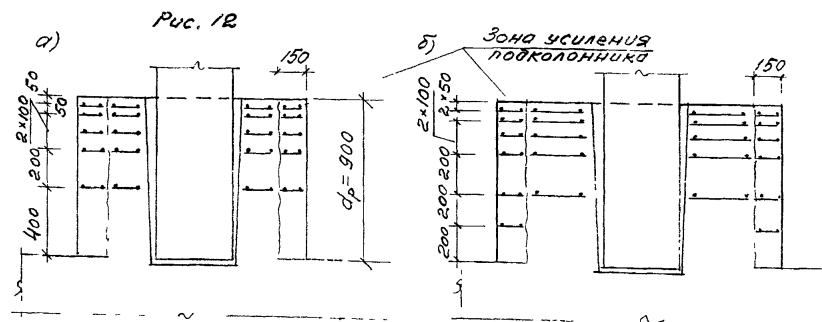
а) поперечное армирование стенок стакана усиленного подколонника фундамента под усиленную рядовую колонну; б) то же, – под связевую колонну.
